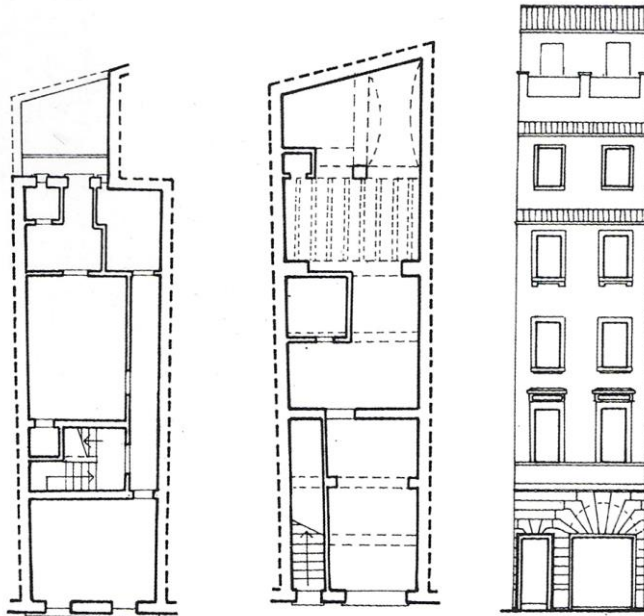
Plantas y alzado del crecimiento de la casa adosada.
